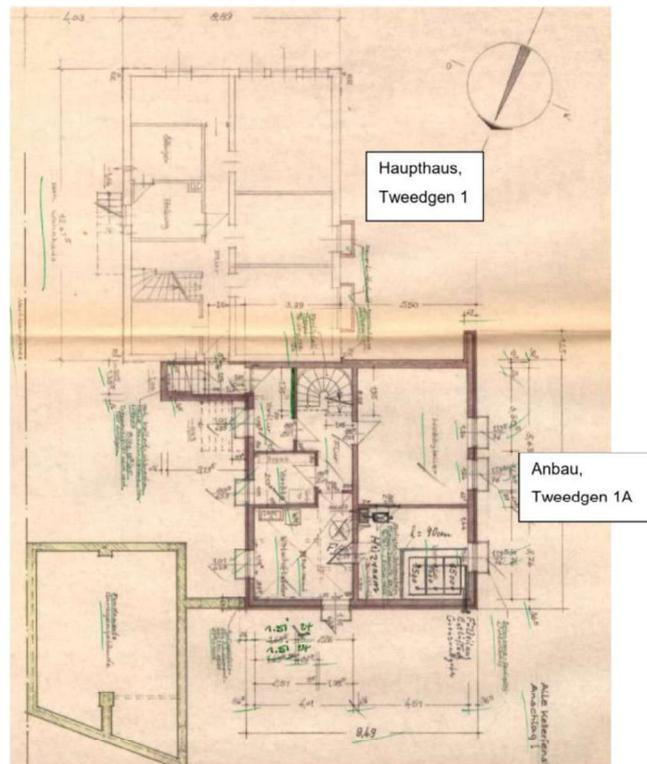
Grundriss von Haupthaus und Anbau, Erdgeschoss
